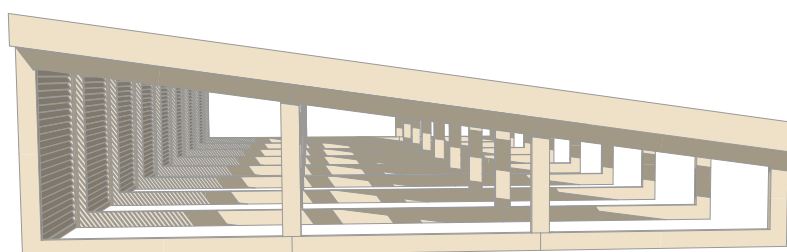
Modelo da estrutura da cobertura em madeira (Fonte: Autora)
